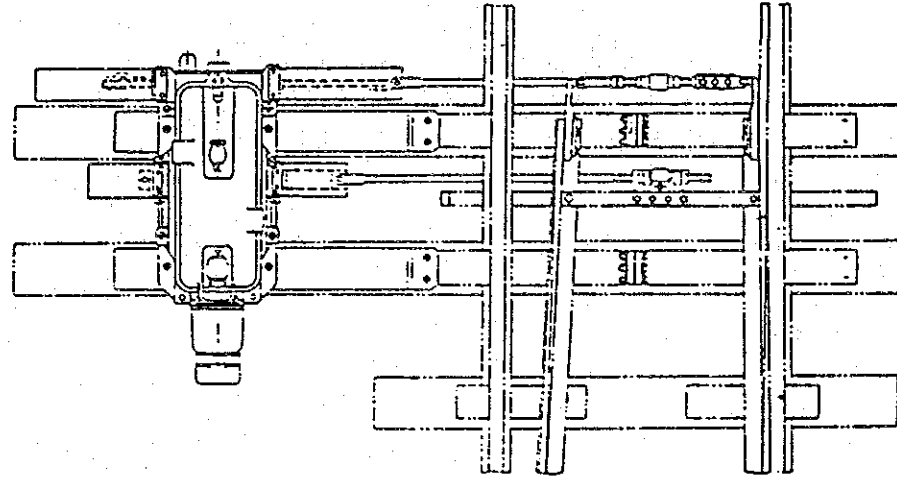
Structure de montage de l'aiguille motorisée à courant alternatif
